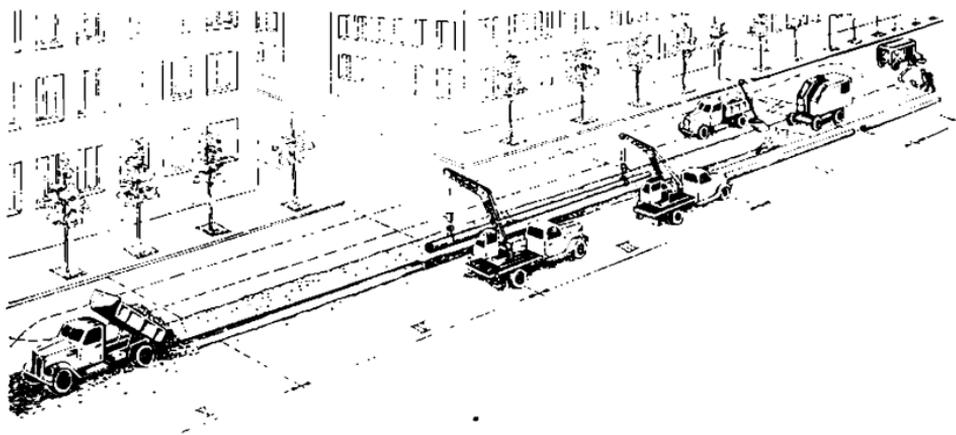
Схема прокладки газопровода с непрерывной засыпкой траншеи
